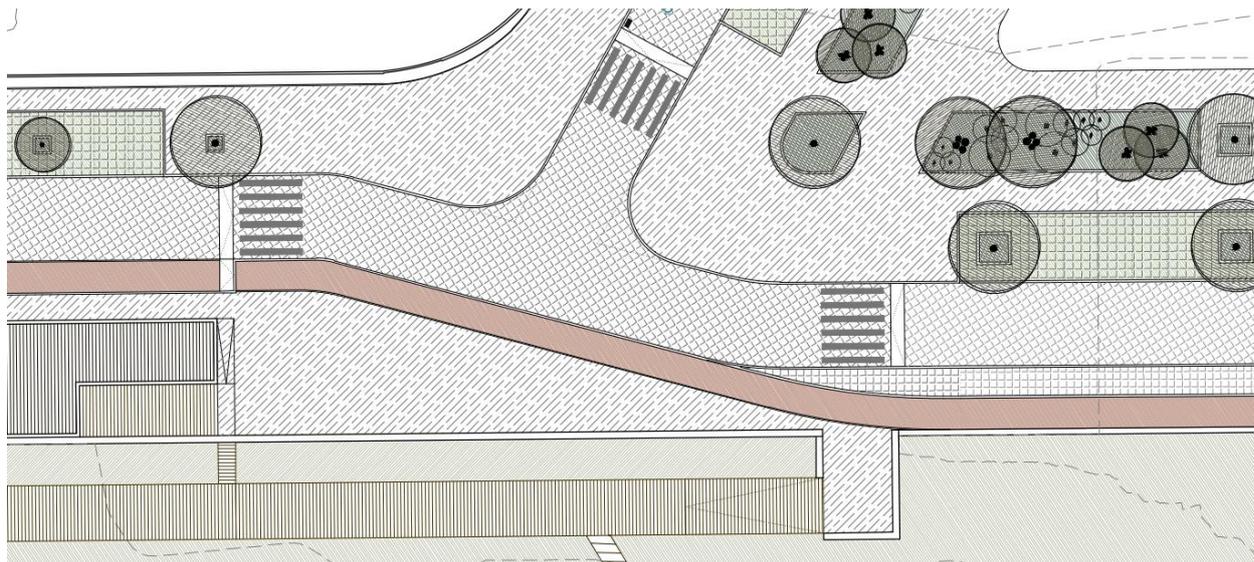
Plano Geral – Troço enviesado do Lado Sul Avenida Marginal
